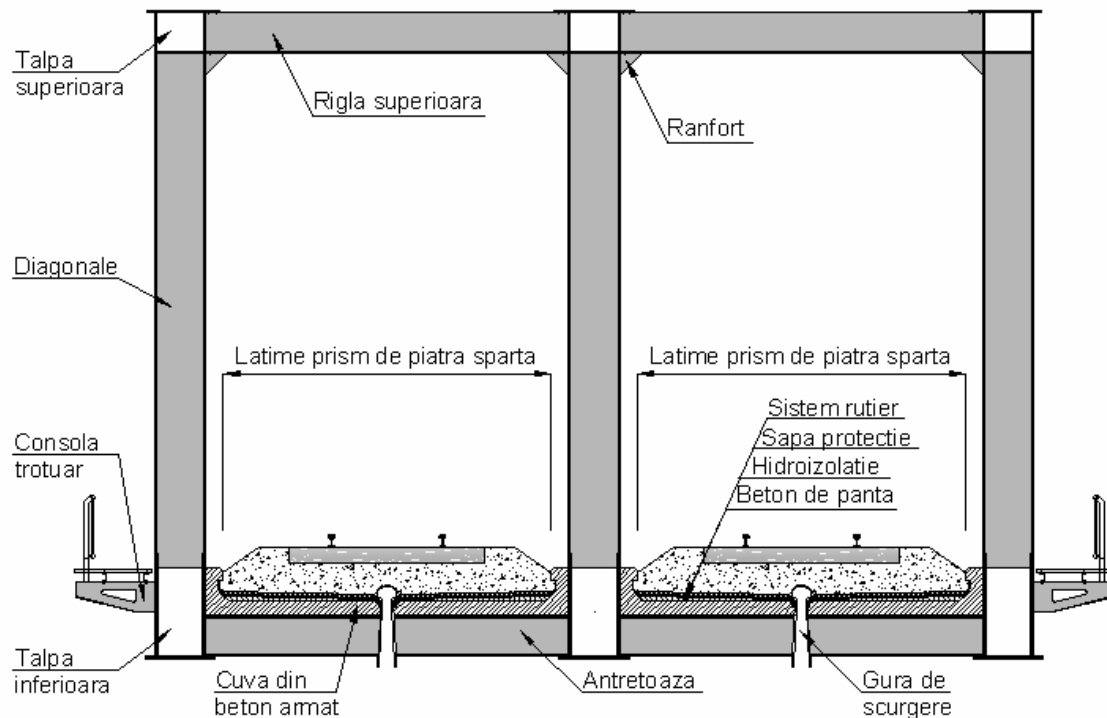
Secțiune transversală prin suprastructura unui pod de cale ferată dublă cu alcătuire mixtă oțel-beton
